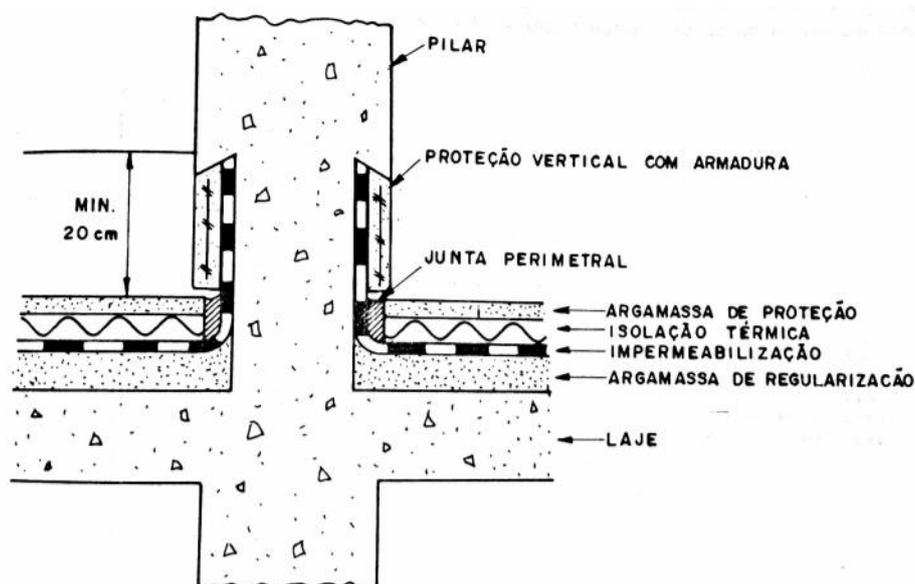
Esquema de impermeabilização junto ao rodapé. Fonte: PICCHI (1986)
